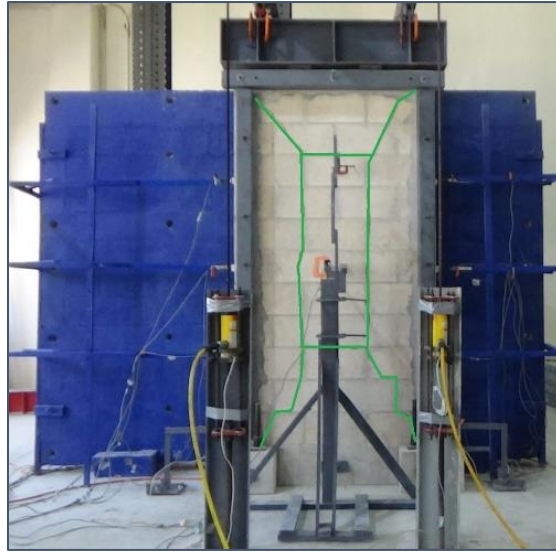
Patrón de agrietamiento final del muro M-2.0-3.33.
